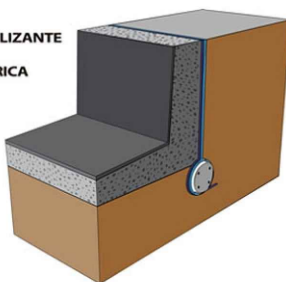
Aplicação de impermeabilização com pintura betuminosa. Disponível em: <http://www.lwartimpermeabilizantes.com.br/muro-de-arrimo-tratamento-extern>
